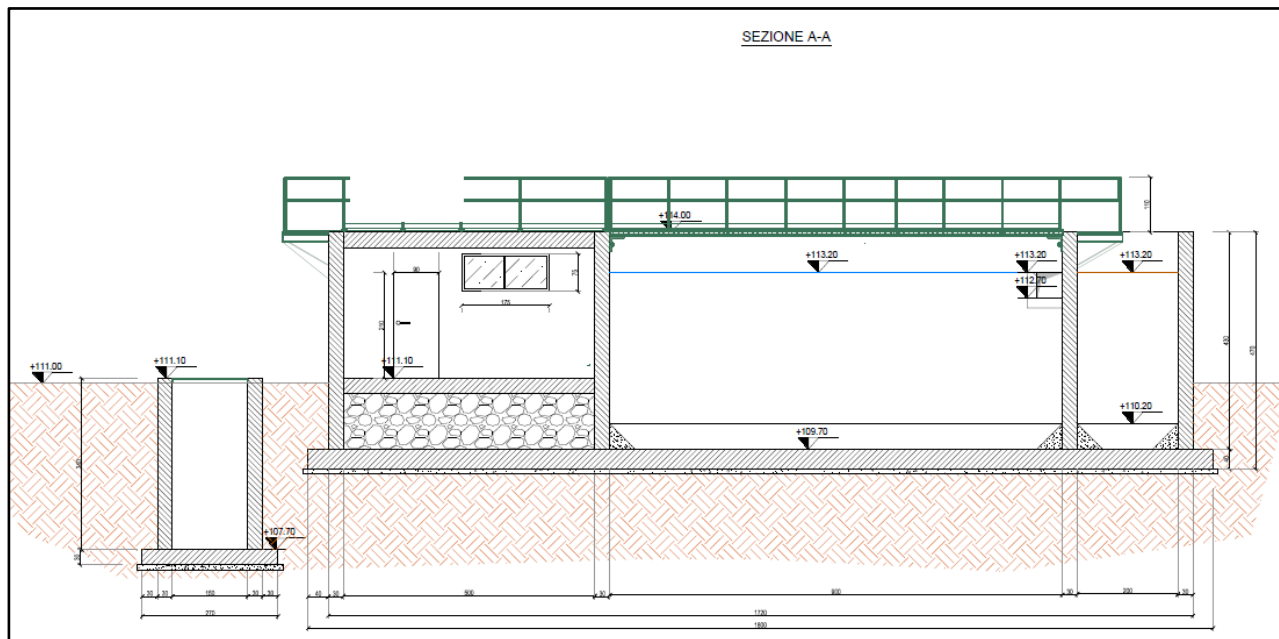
Sezione A-A impianto di depurazione in progetto (DA Sollevamento e monoblocco - opere civili: Pianta e sezioni).
